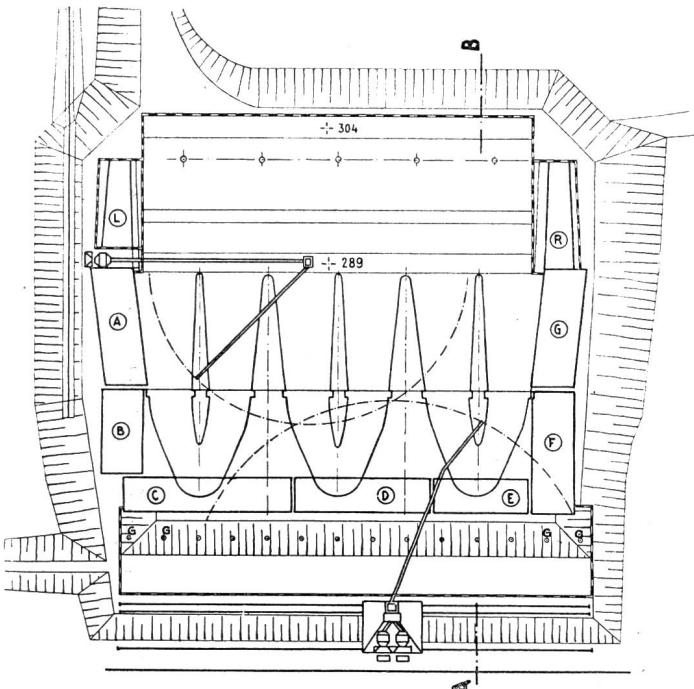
Kraftwerk Albbrück-Dogern. Fundierung des Maschinenhauses. Grundriß. Maßstab: 1 : 1500.
